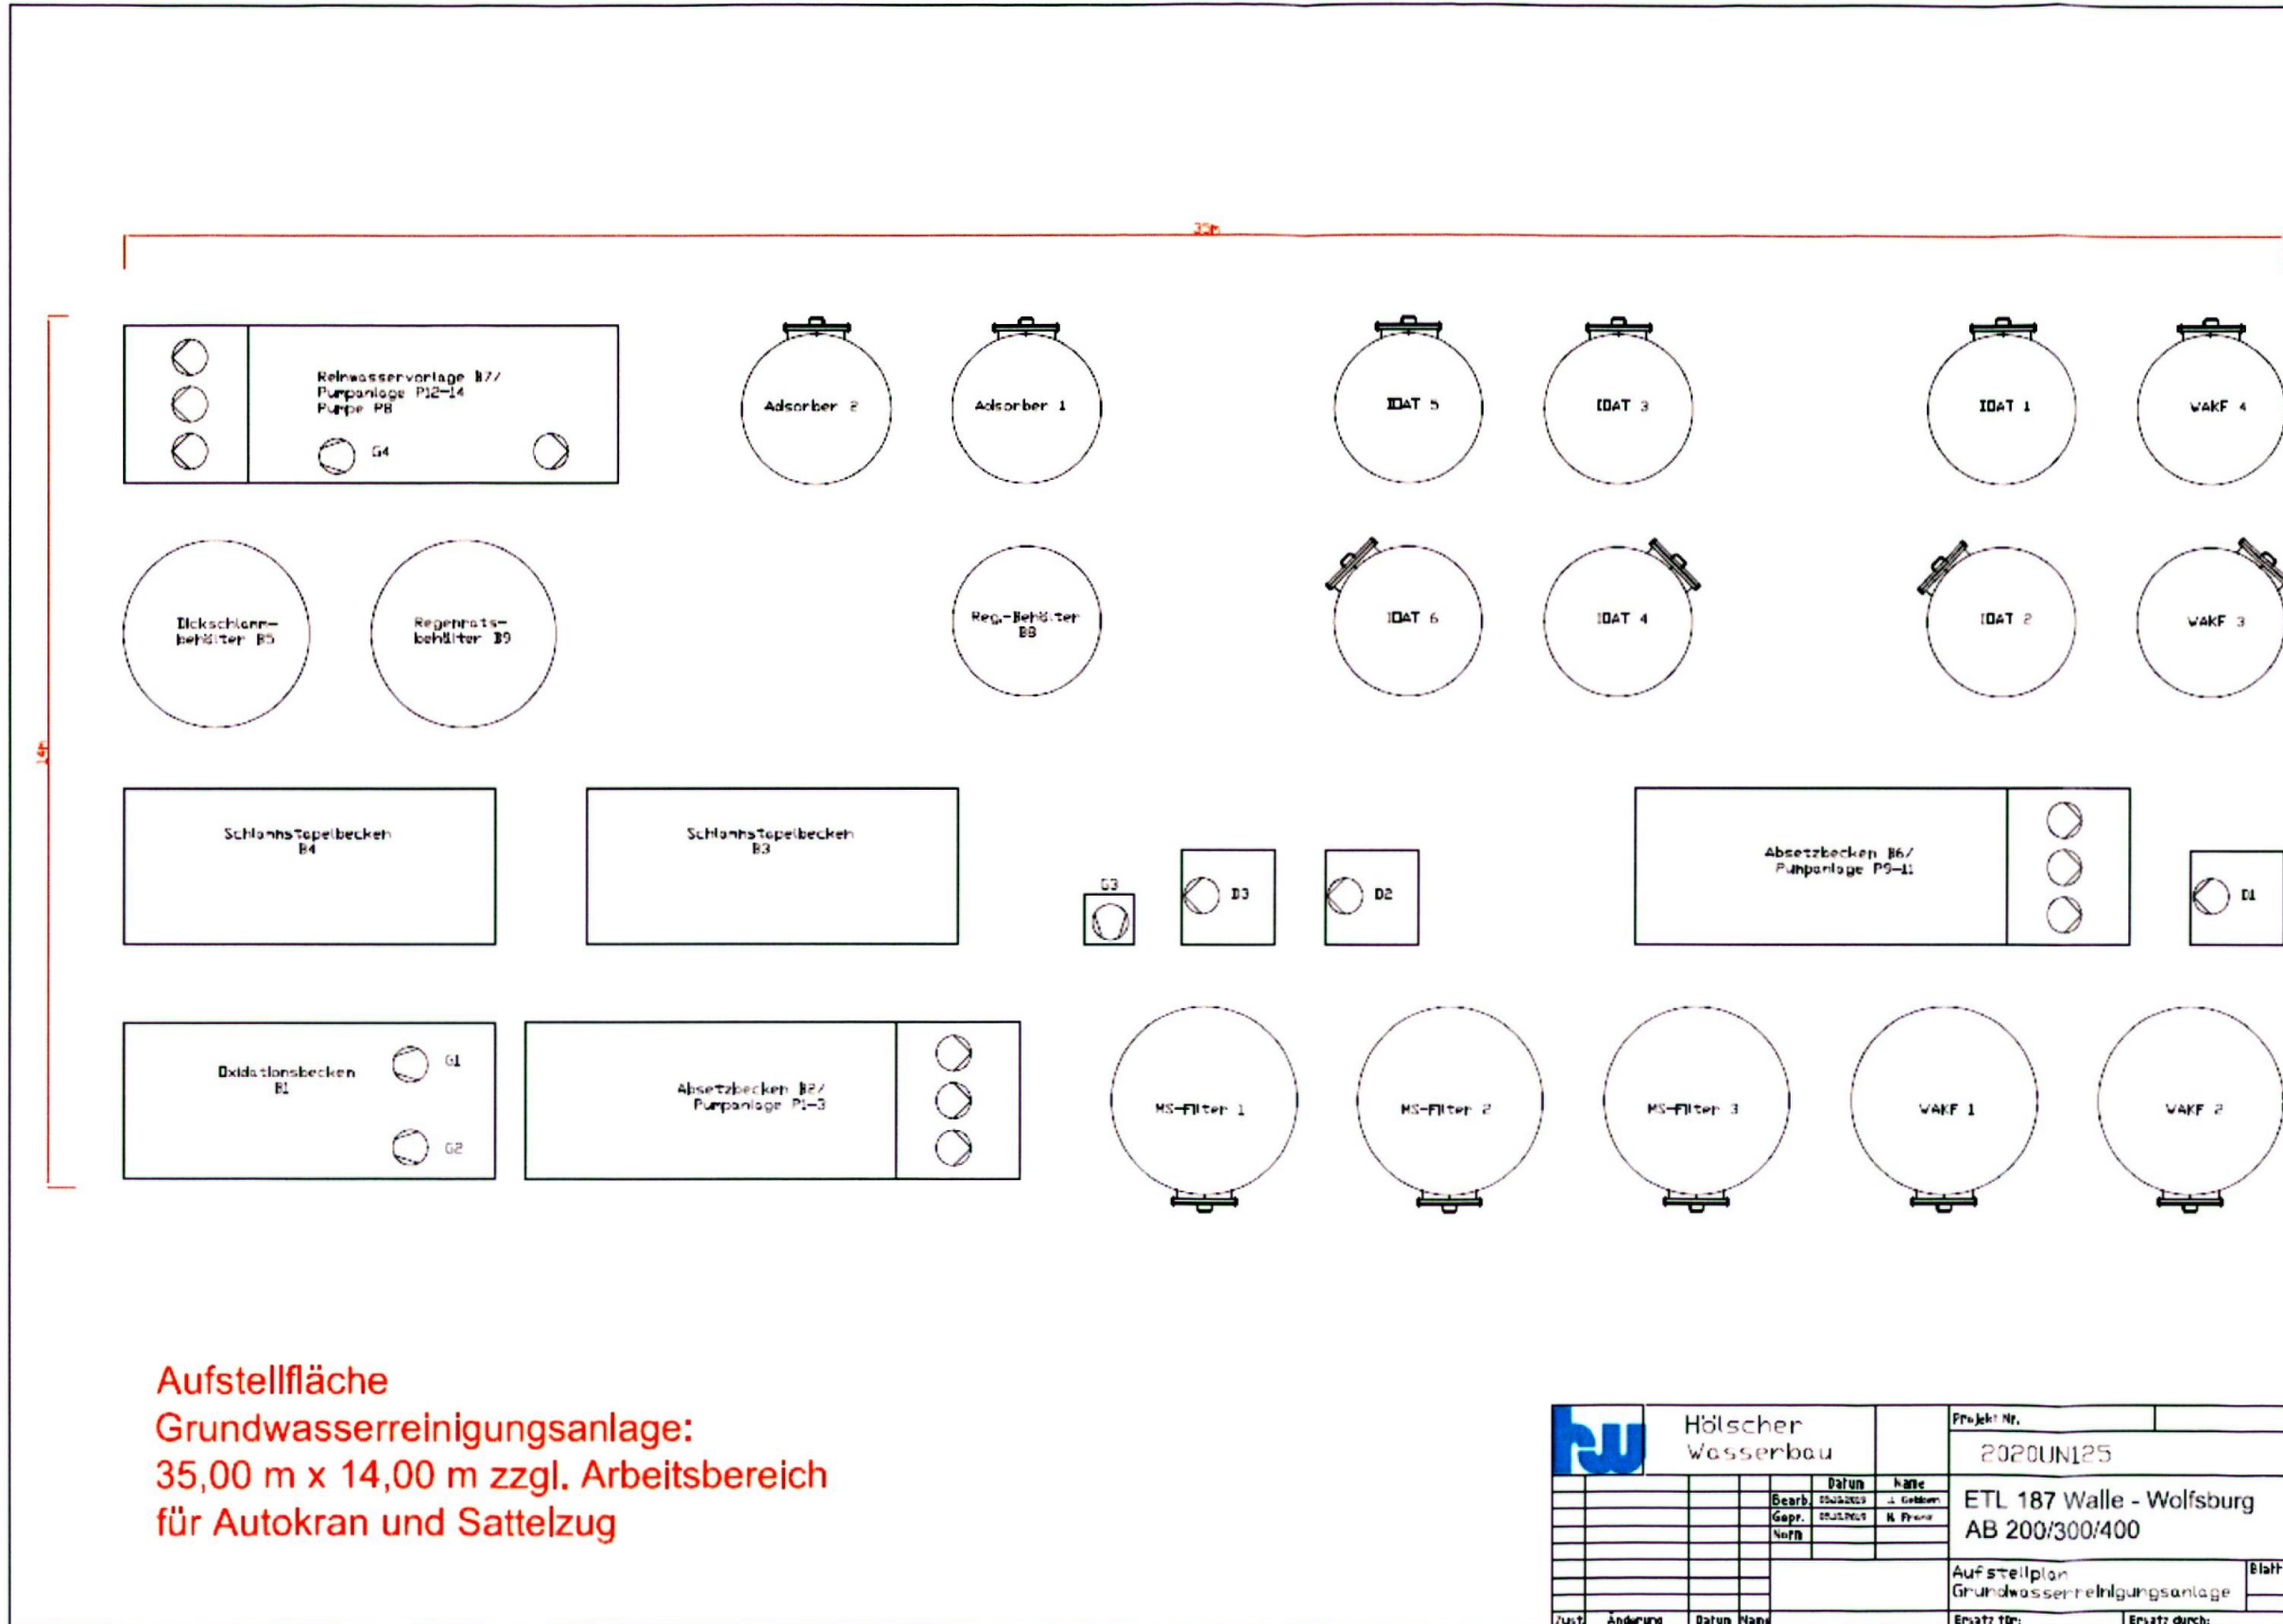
Aufstellplan Grundwasserreinigungsanlage
